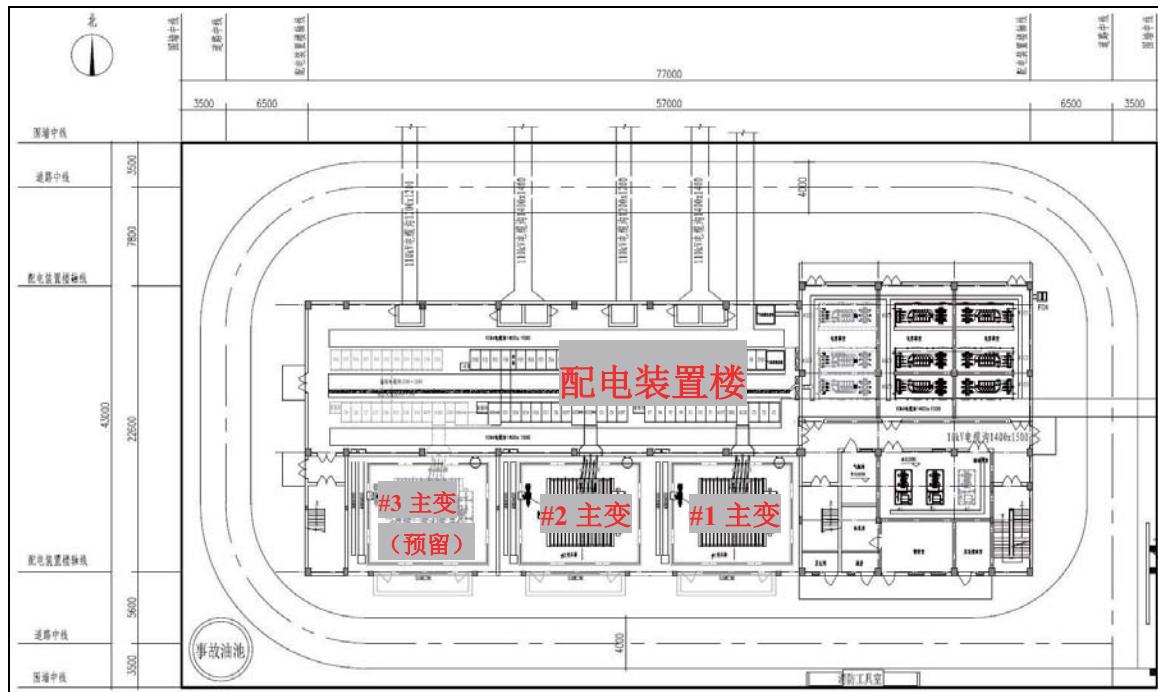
110 千伏玉溪(荷茶)站总平面布置示意图
